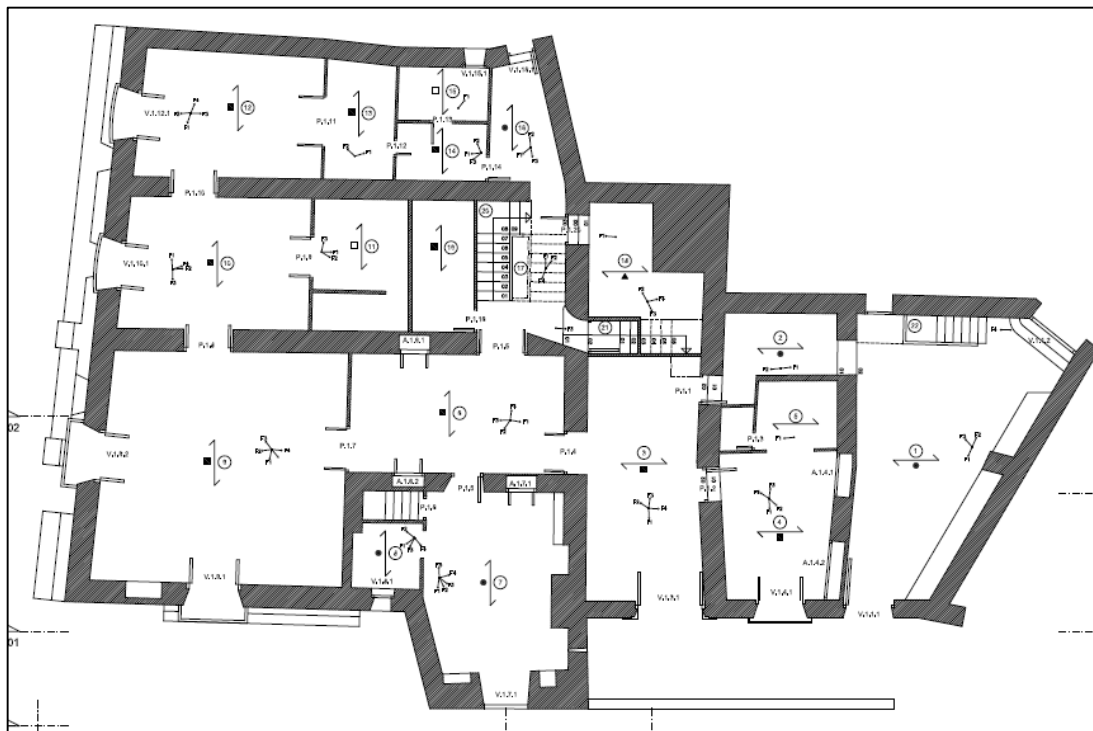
Plano que corresponde a la realidad, de planta baja.
